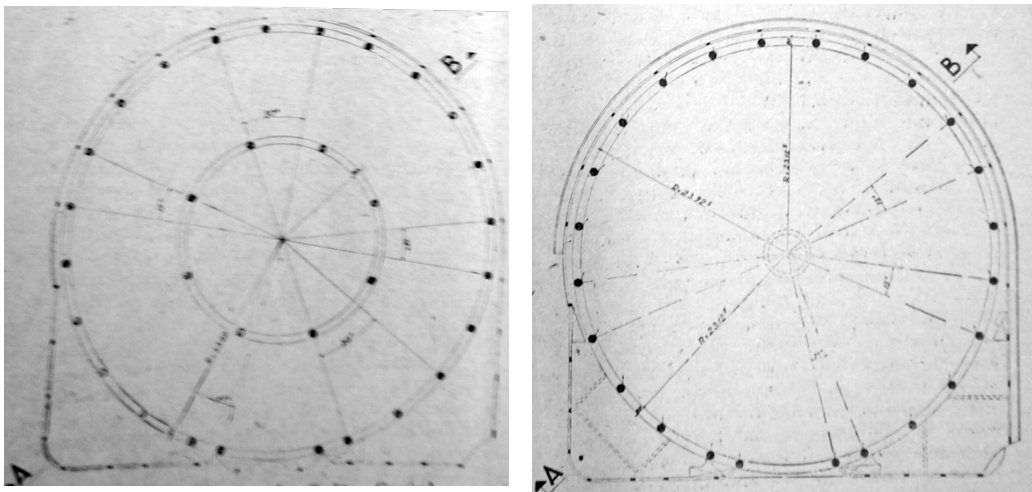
Esq. Planta-baixa salão social. Dir. Planta de cobertura salão social. FONTE: CONCRETO, 1943.
